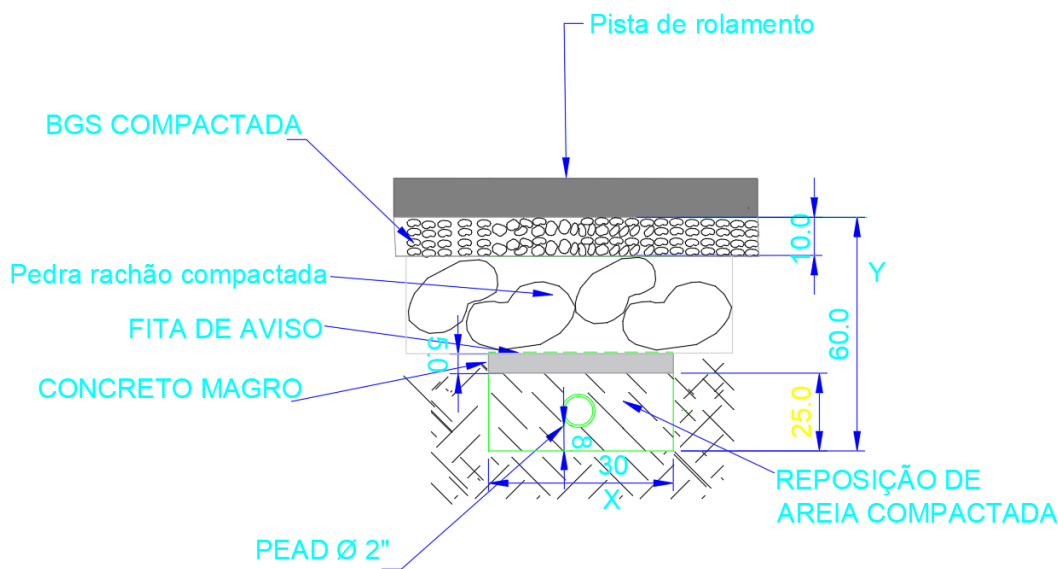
Perfil executado da infraestrutura de iluminação na pista de rolamento
